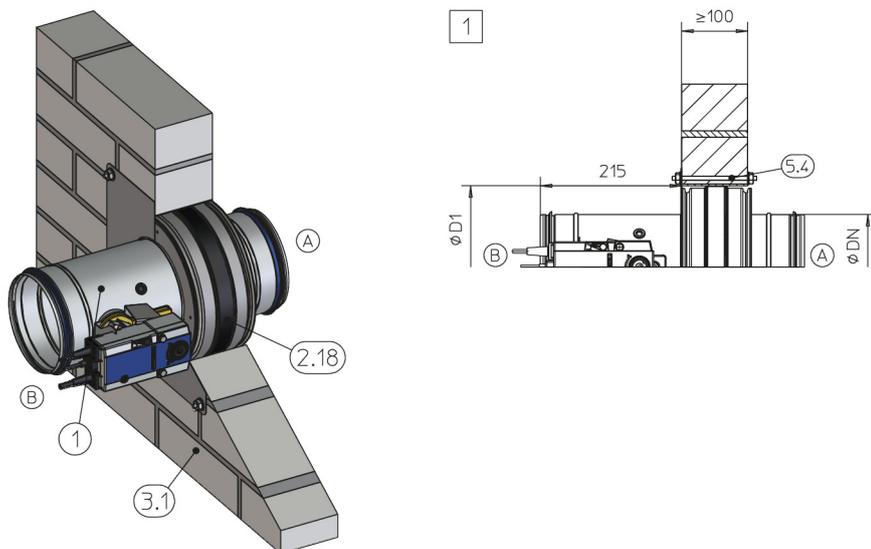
Montage à base de mortier dans un mur plein avec un joint de plafond souple
